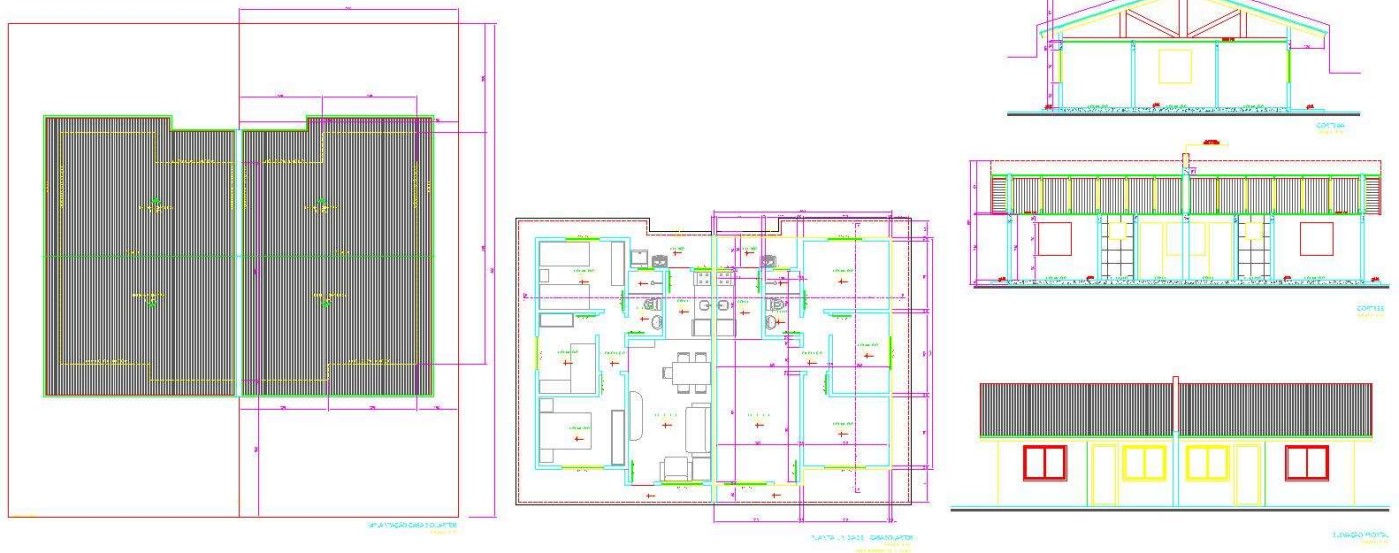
Planta baixa, cortes e vistas - modelo 3 quartos.
